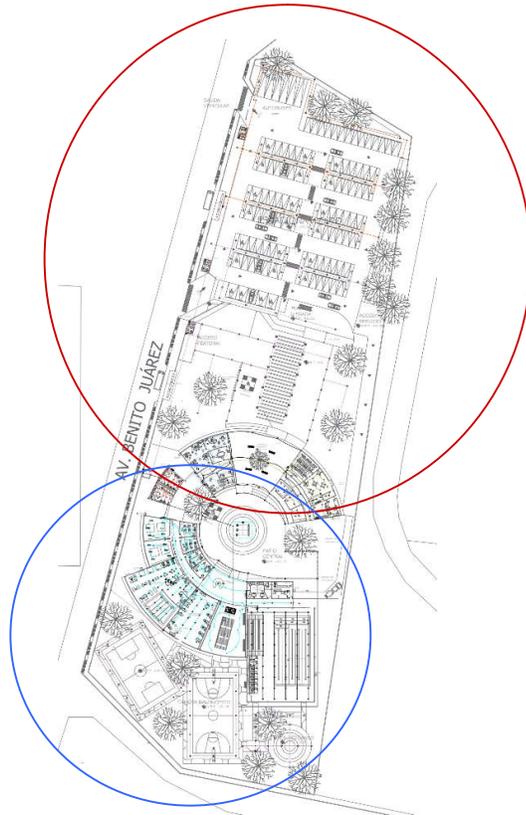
Plano de Conjunto, se logra visualizar las dos áreas en las que se divide la propuesta eléctrica, Fuente; Plano IE-01
